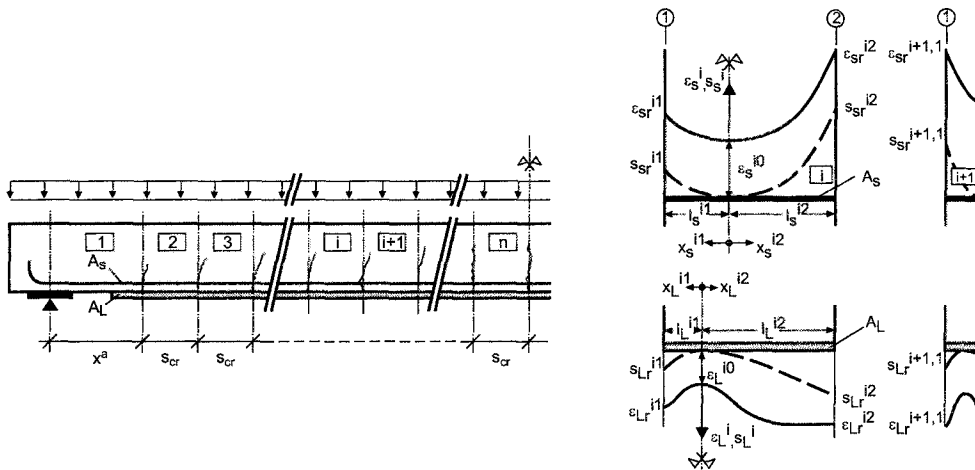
Rechenmodell - Elementierung, Bezeichnungen eines Elementes
